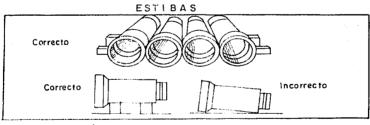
INSTRUCTIVO DE COLOCACION DE TUBERIA
